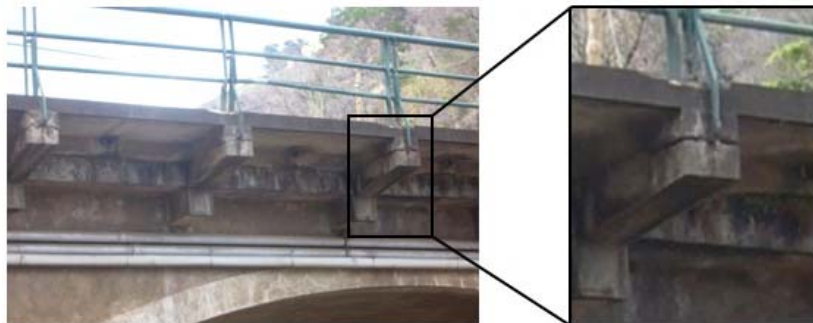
Vigas Transversais fissuradas (Novembro de 2013)
